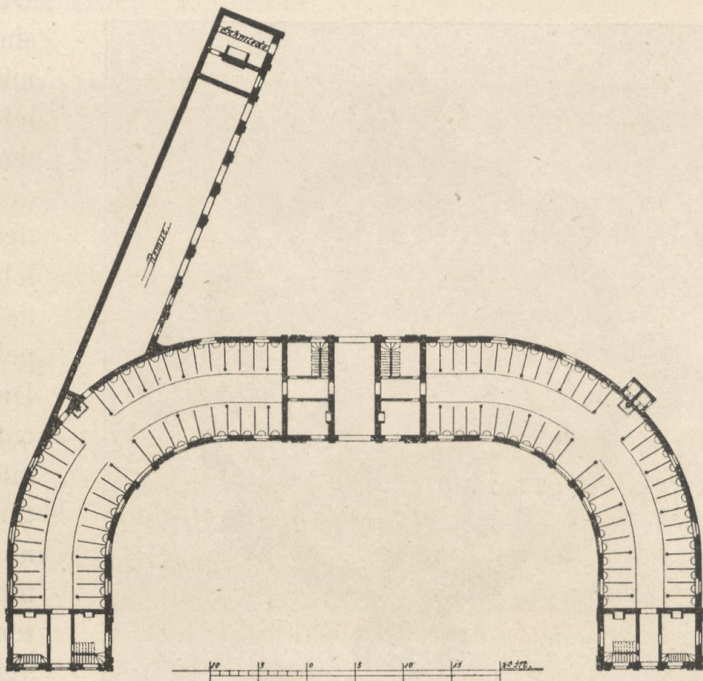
Clemenswerth, Grundriss des Marstalls.
